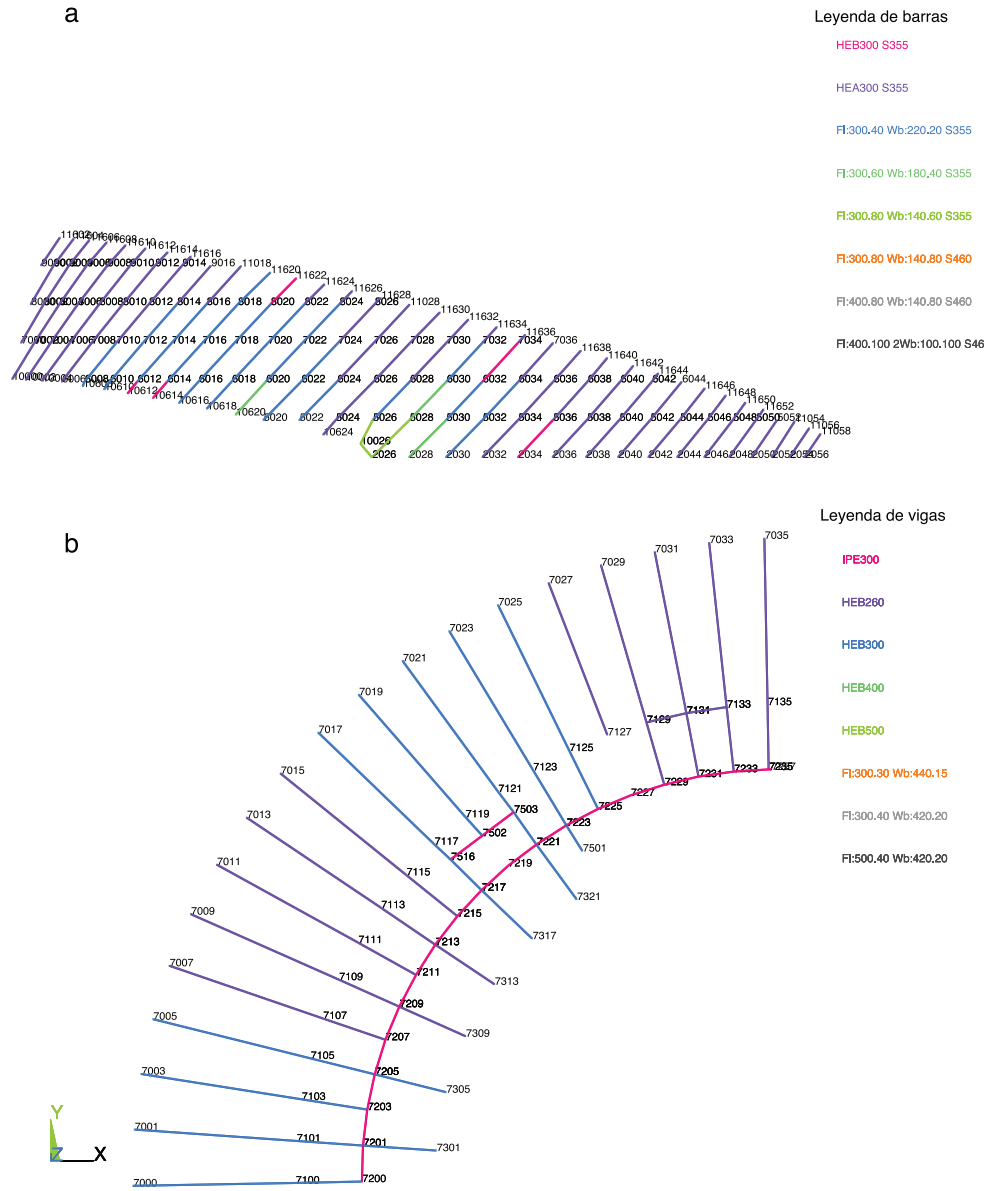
Gráficos de comprobación de la entrada de datos para las diagonales de la celosía exterior, lado izquierdo (a), y las vigas de la planta 3, lado derecho (b).
